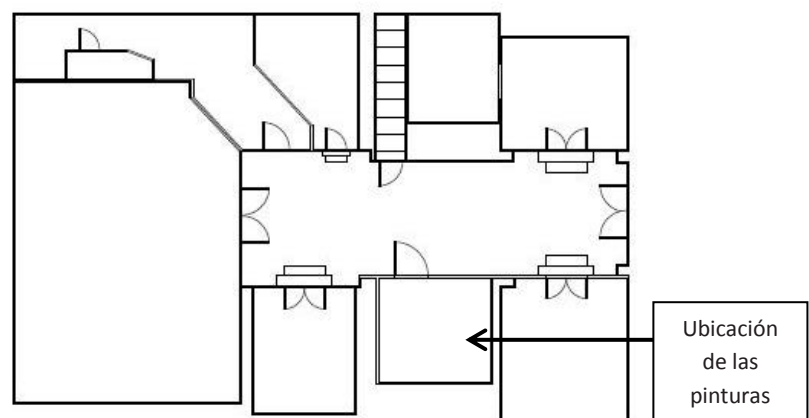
Planta baja de la vivienda perteneciente a la familia Falcó.
